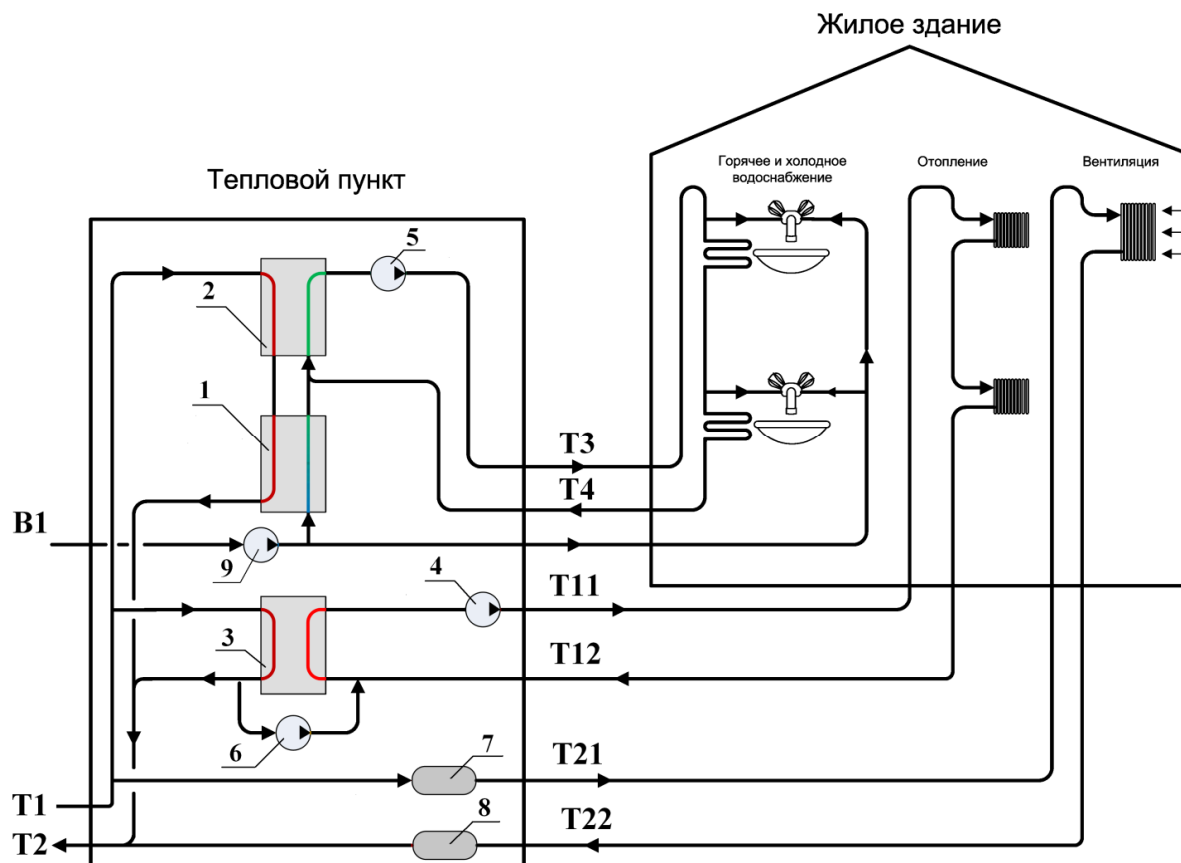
1 – Схема трубопроводов от ЦТП к зданию:
